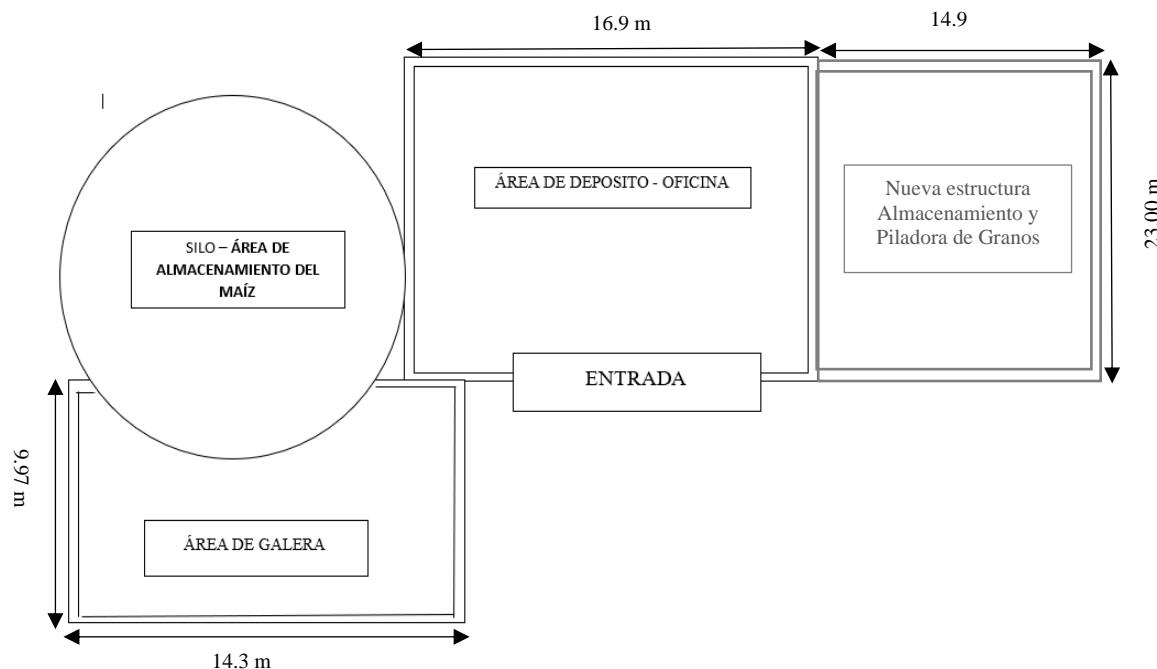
Planta Arquitectónica del anexo a la estructura existente.
